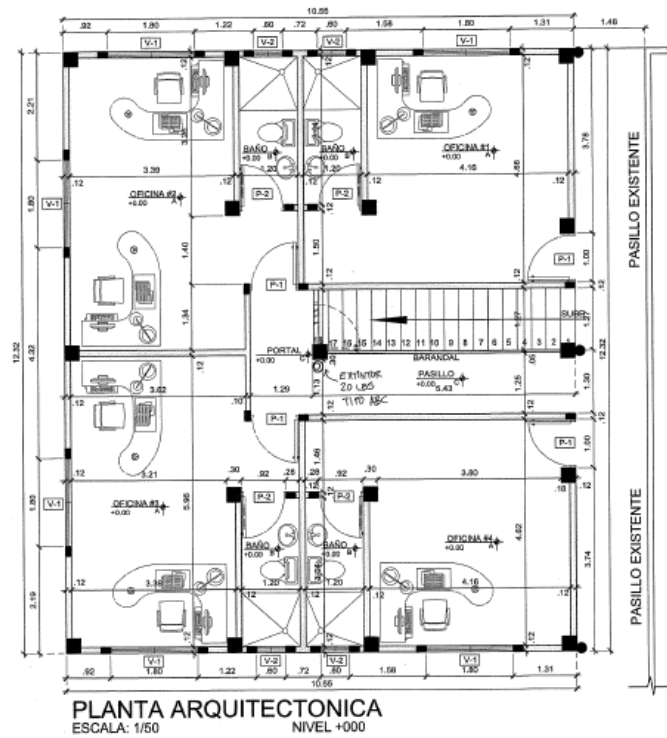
Planta arquitectónica del proyecto nivel +000. Fuente. Plano del proyecto
